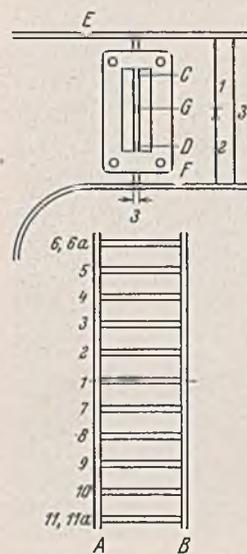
Schweißplan der Baustellenschweißungen.
